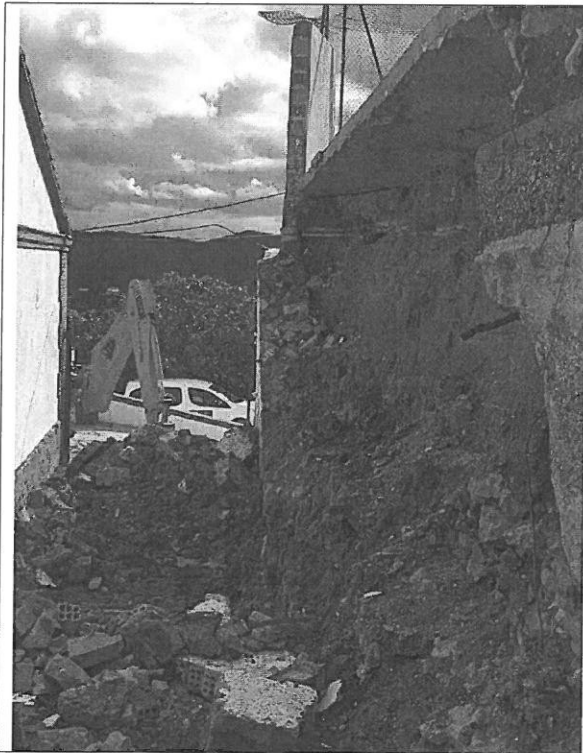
Se procede a la retirada del muro derruido y la limpieza del callejón.
